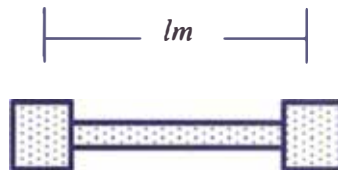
Muros de concreto armado con columnas en extremo
